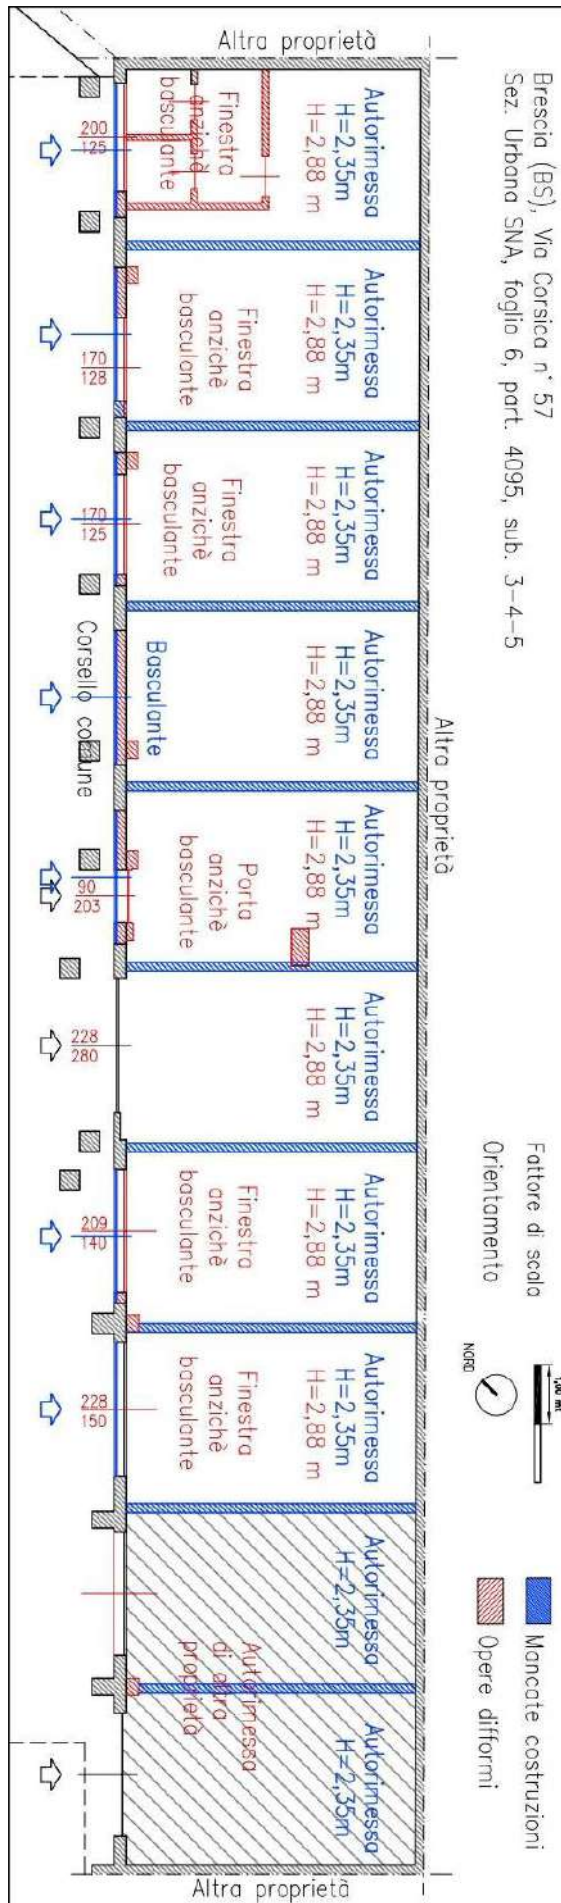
Pianta di confronto dell'immobile oggetto di perizia con ultima pratica edilizia approvata
